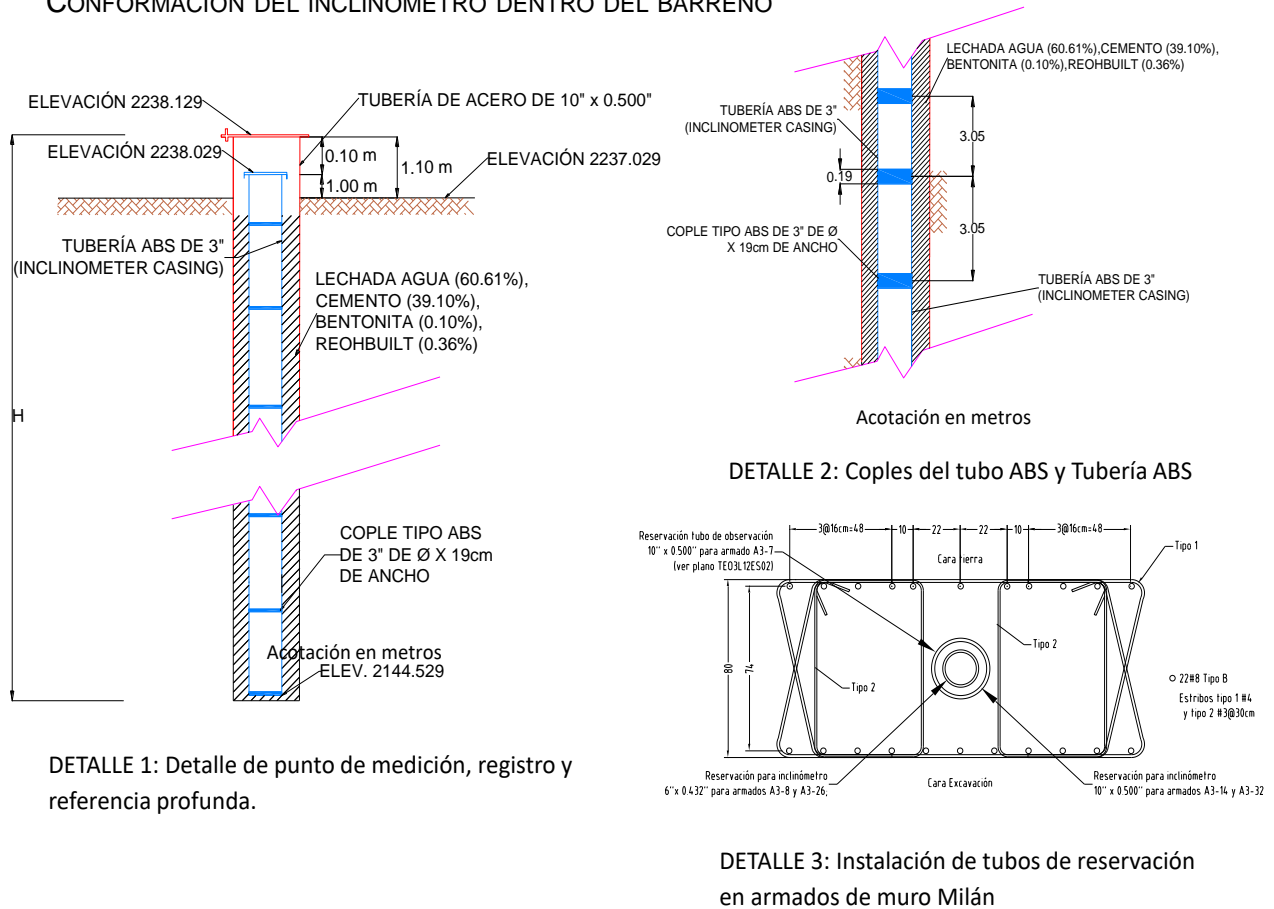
Diseño de inclinómetro para la lumbrera L-12 y detalles de su construcción (Fuente: CONAGUA-COMISSA, 2011)
